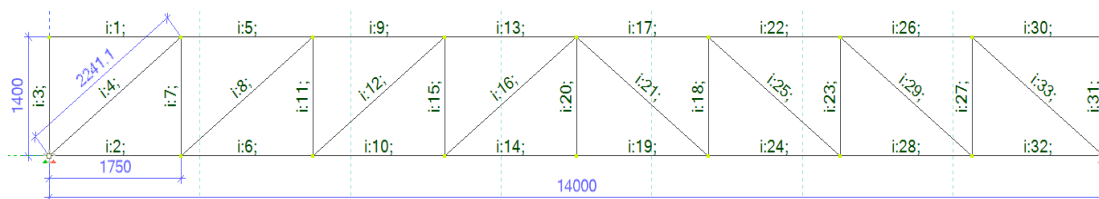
Расчетная схема фермы с номерами элементов и с граничными условиями в ПК Лира 10.12
